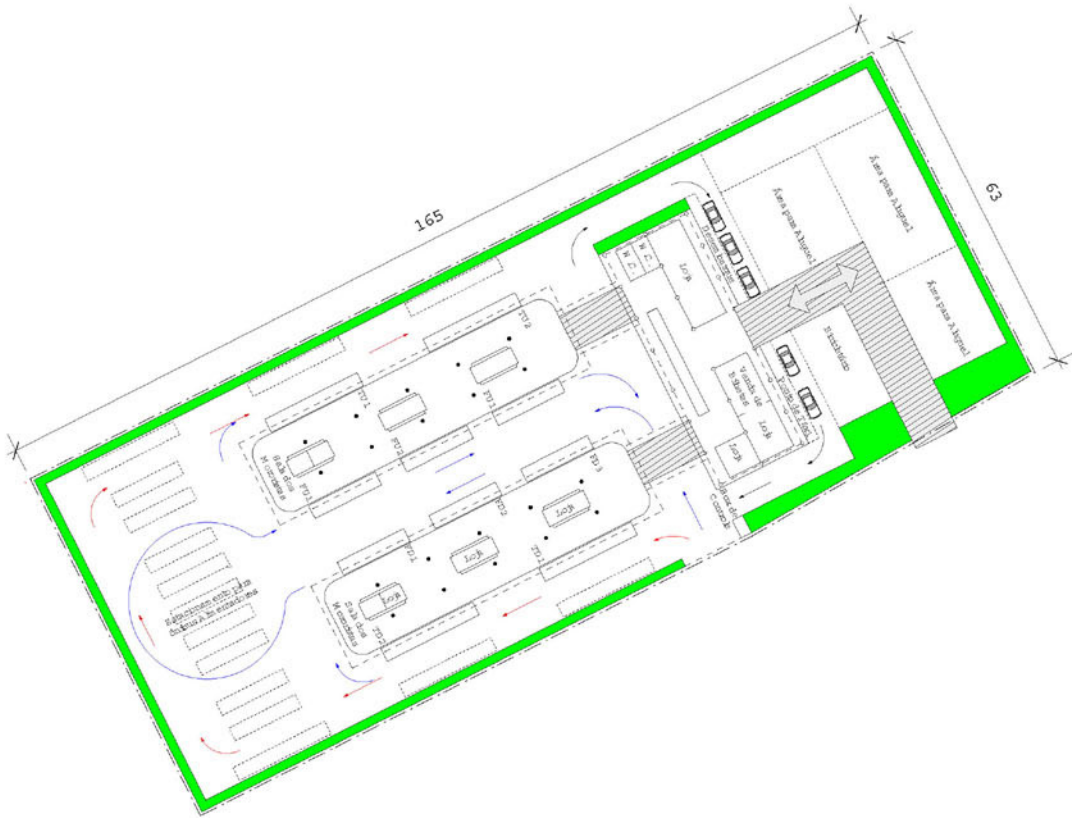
Localização e Planta do Terminal G: Independência 1 (sem escala)
